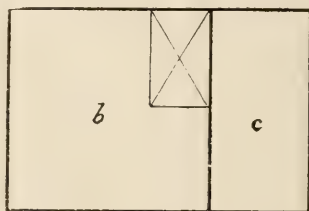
Plan d'un logement pour un ménage d'ouvrier.
